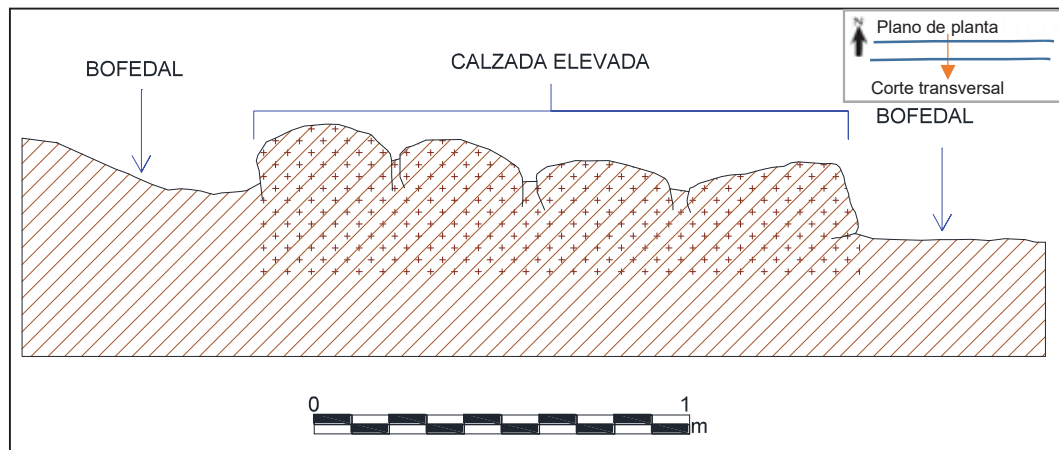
Dibujo de corte transversal del camino ritual de calzada elevada. (Fig. 77)
